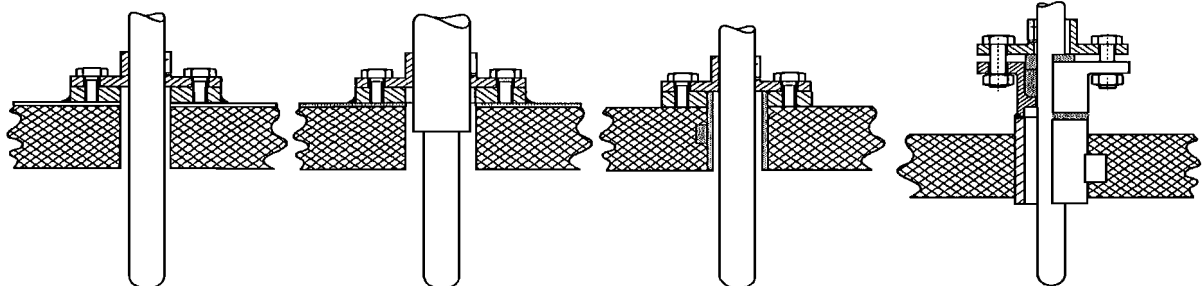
Montage des Anschlagflansches an einer aufgeschweißten Gewindeplatte.
